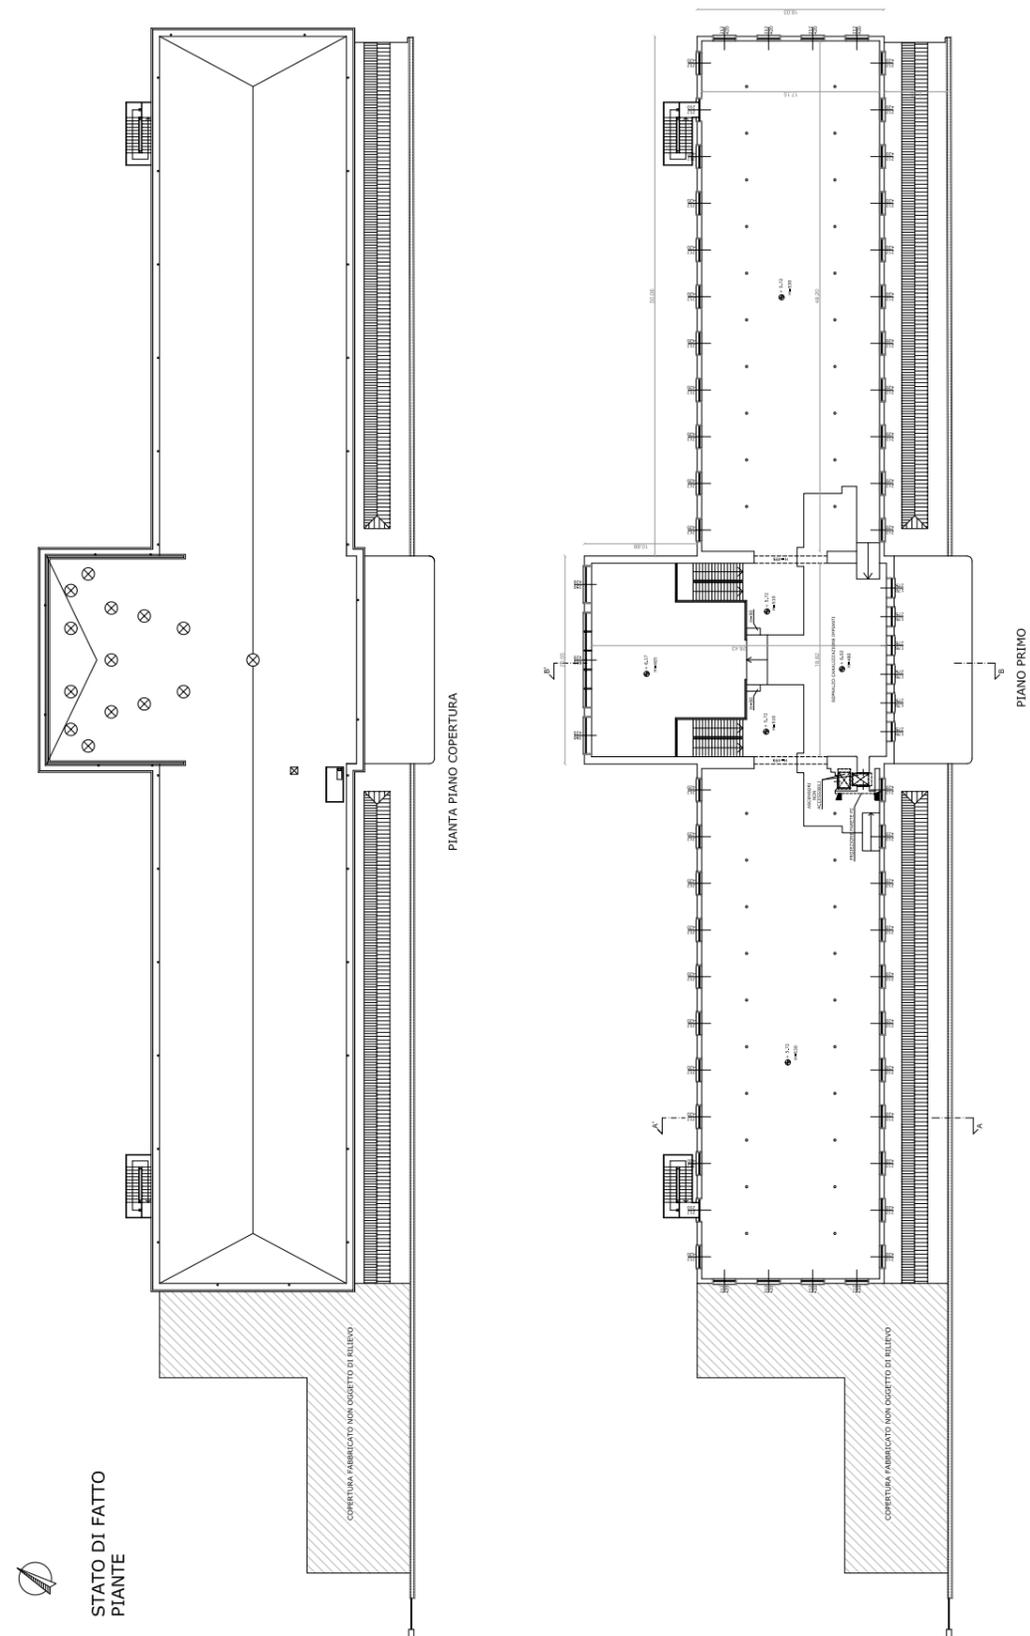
| “Stato di fatto - Pianta piano copertura e primo piano“, 2011 | fonte: Arch. Marina Basso
